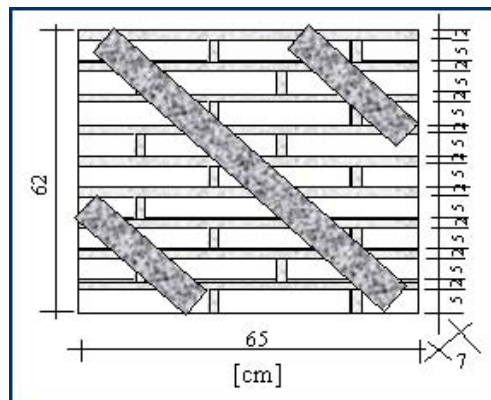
Muro reforzado con tejido de fibras de carbono
